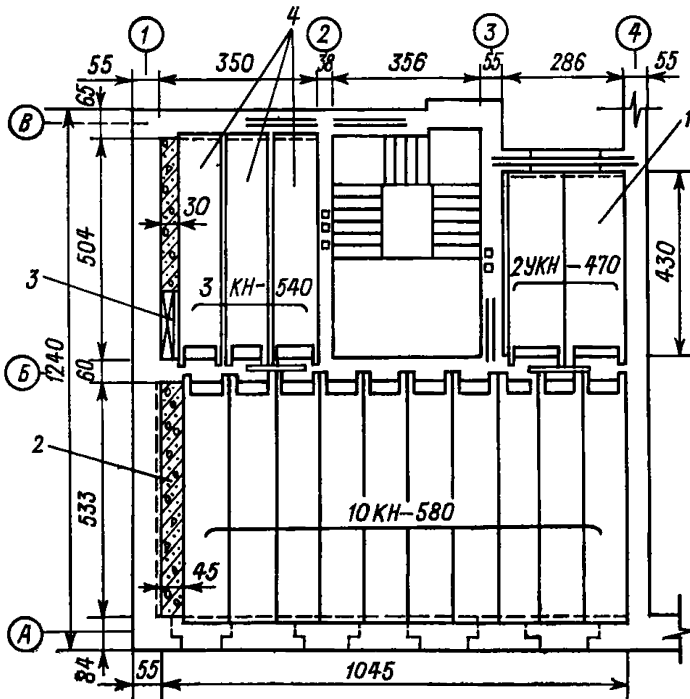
План участка перекрытия из железобетонных двухпустотных настилов КН
